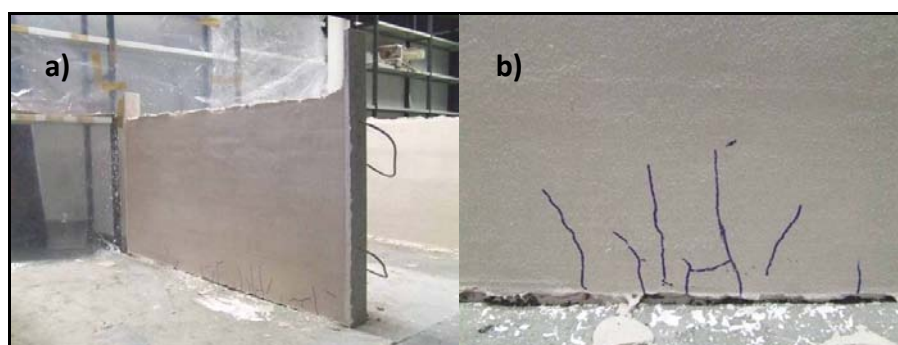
Localização das fissuras na parede P2: a) Vista geral; b) Pormenor.
